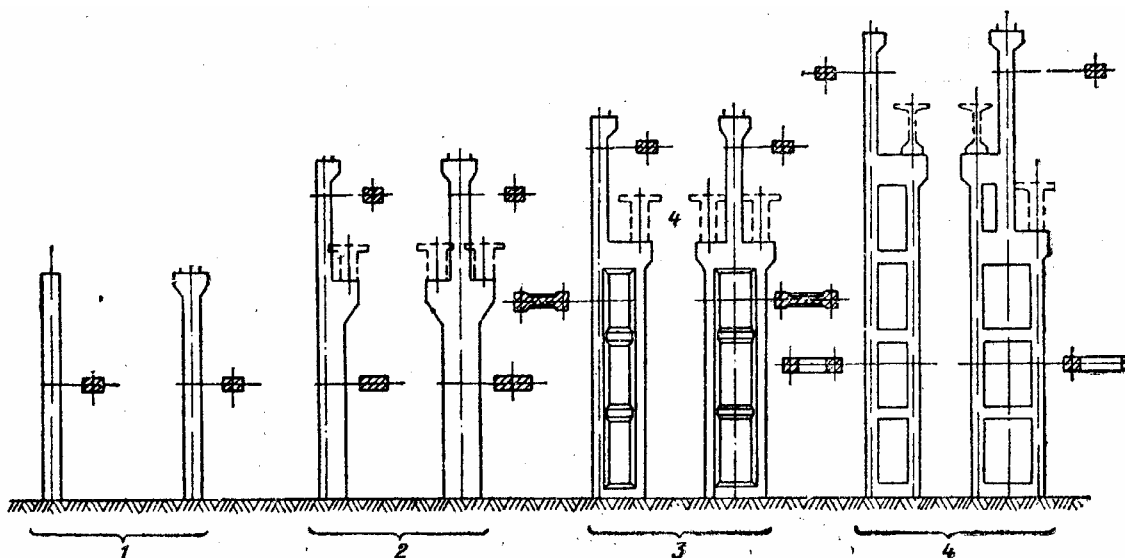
Железобетонные сборные колонны одноэтажных промышленных зданий
